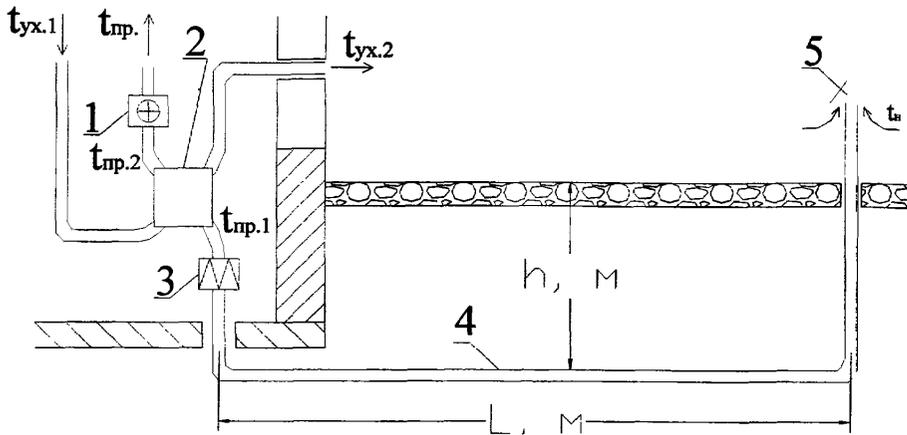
Принципиальная схема вентиляции здания с утилизацией теплоты грунта и вытяжного воздуха: 1 – пиковый догреватель; 2 – утилизатор теплоты; 3 – фильтр; 4 – грунтовый теплообменник; 5 – воздухозаборный оголовок
